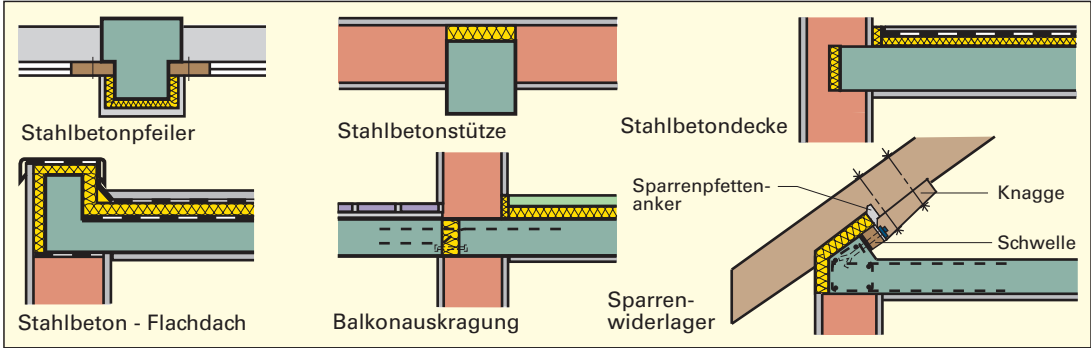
Wärmedämmung zur Vermeidung von Wärmebrücken
